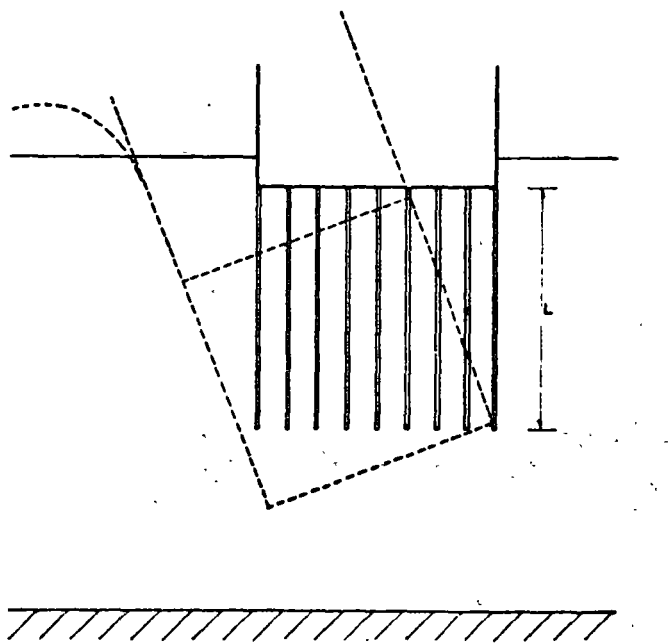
Falla de conjunto de una cimentación con pilotes de fricción
